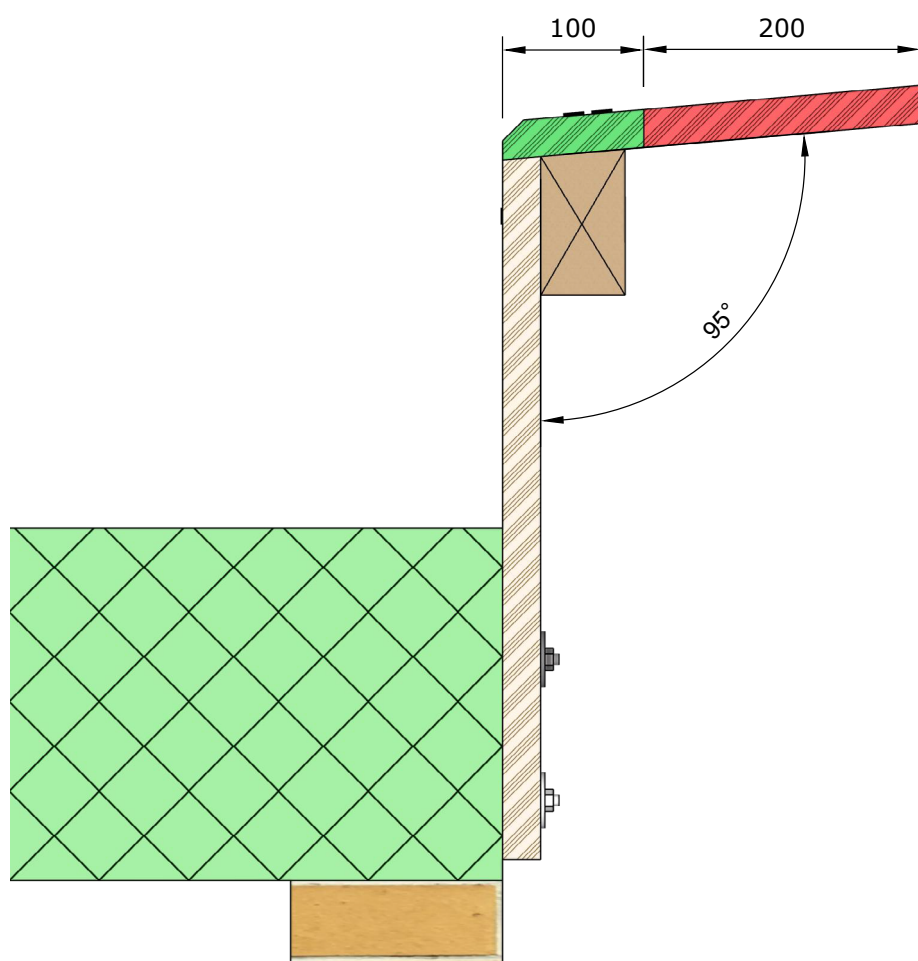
Schnitt durch Dachrandkonstruktion beschränkt betretbar, Masse in mm.
